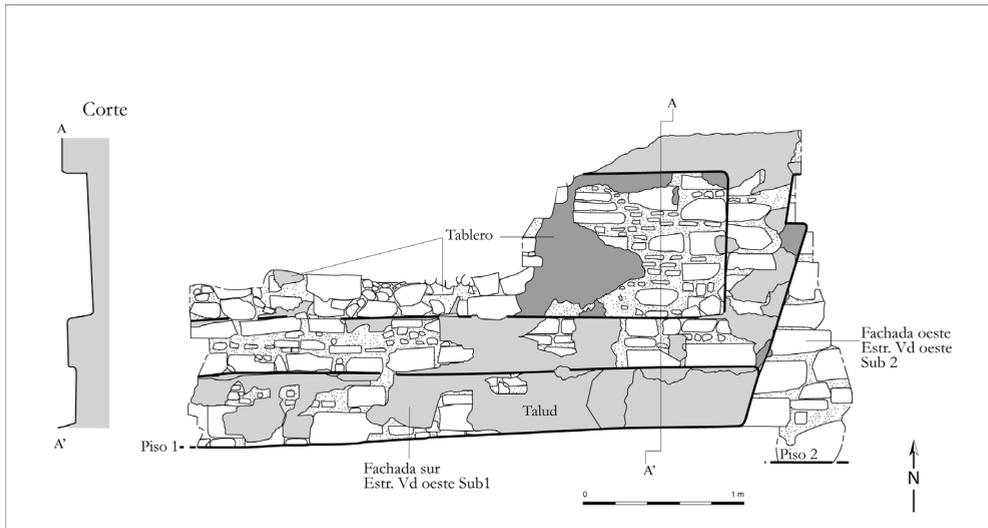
Estructura Vd oeste sub 1 de Naachtun. Alzado de la fachada sur con talud-tablero (levantamiento y digitalización de Johann Begel).
